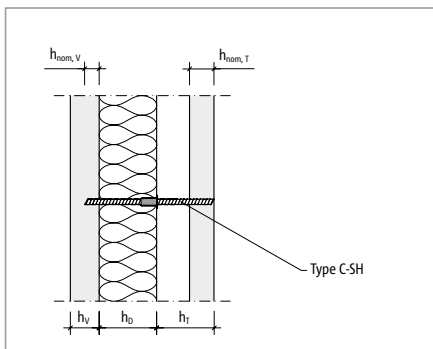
Schöck Isolink® type C-SH: données de la section du mur préfabriqué;  $h_{nom,V} < h_V$
